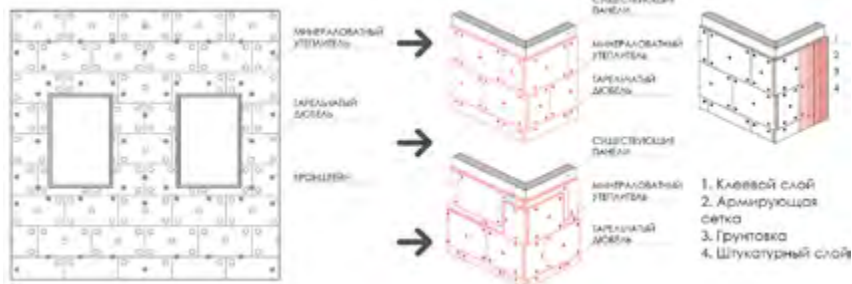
Принципиальные схемы утепления фасадов панельных зданий
